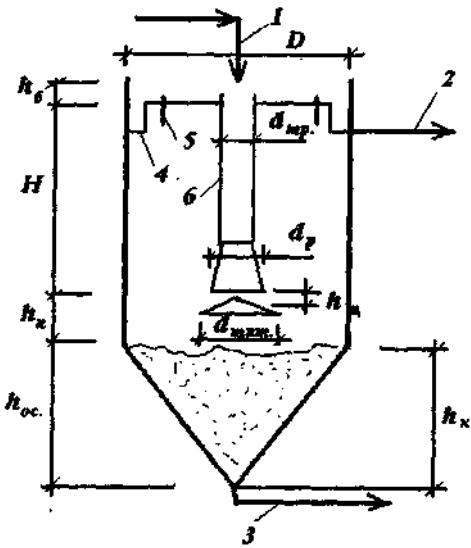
Розрахункова схема вертикального відстійника:
